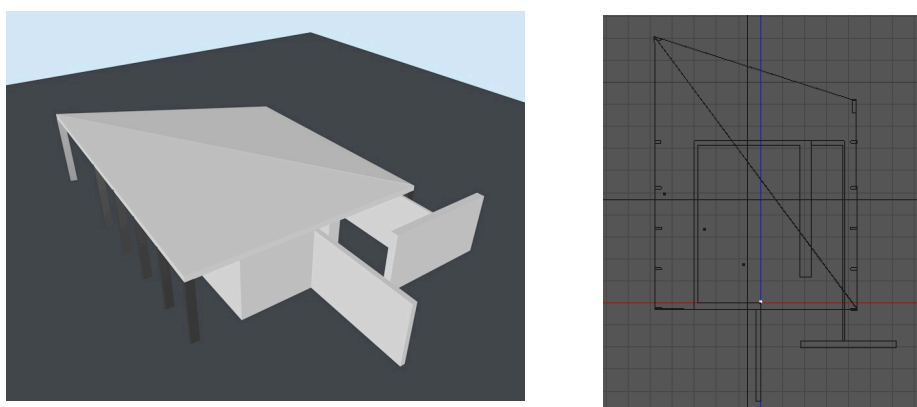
planta amb pilars i sostre, al dreta visor superior C4D
